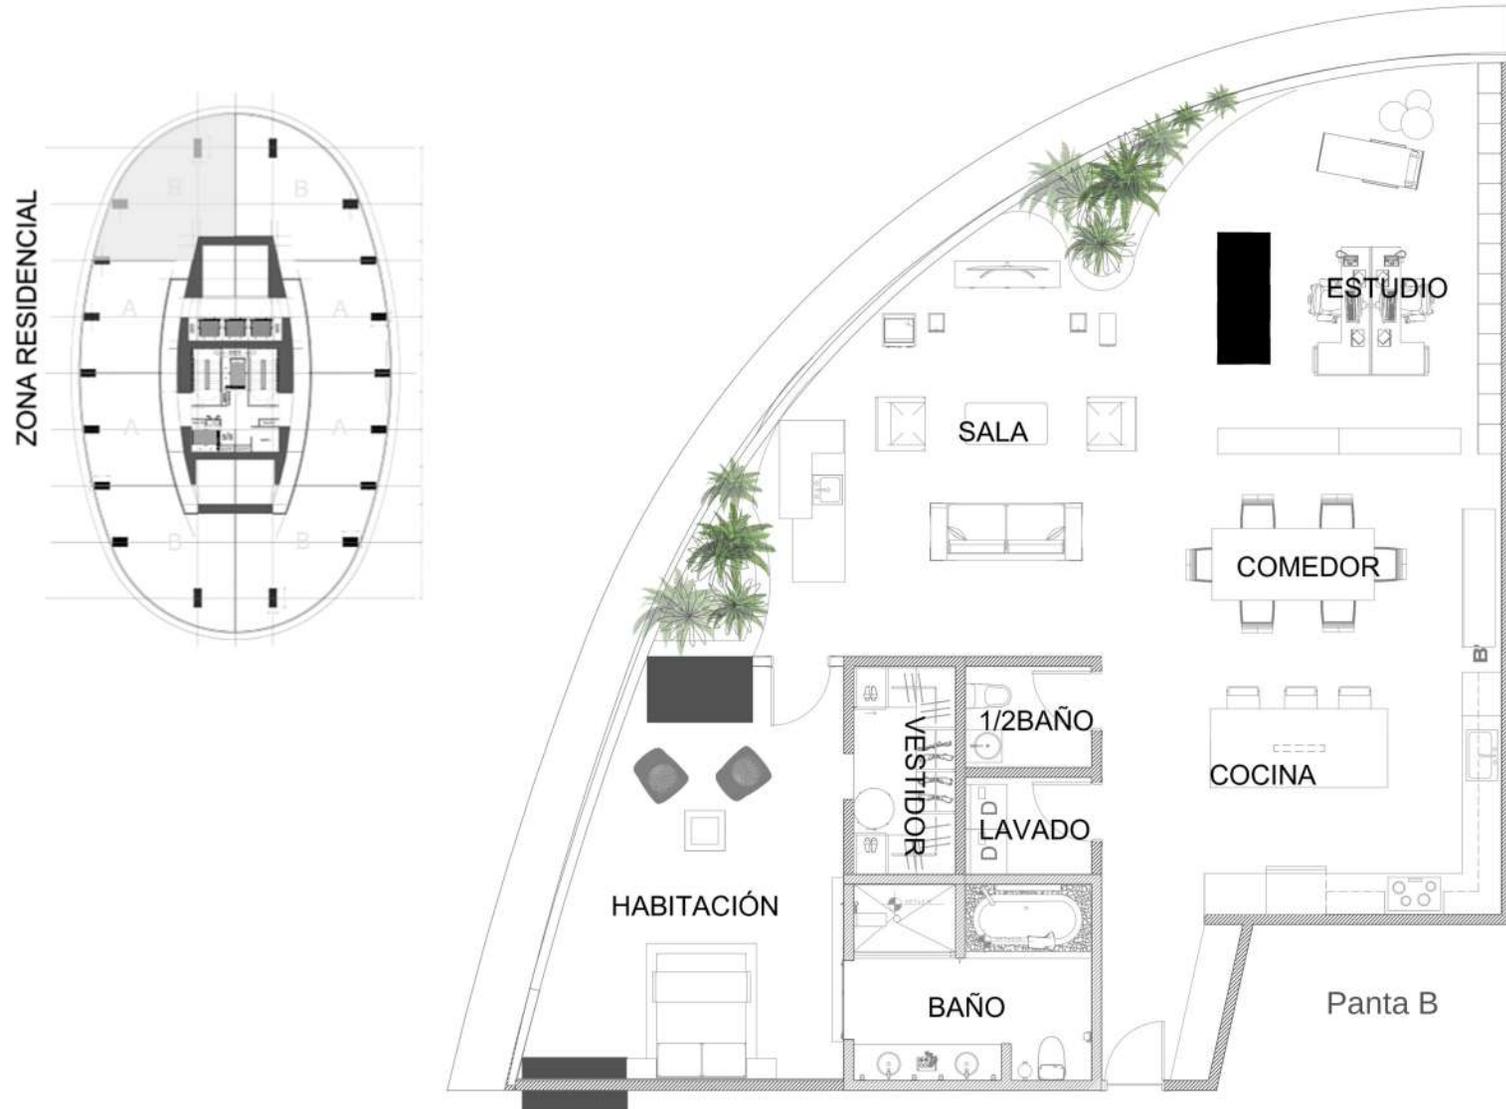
Planta arquitectónica. Elaboración propia, 2022
